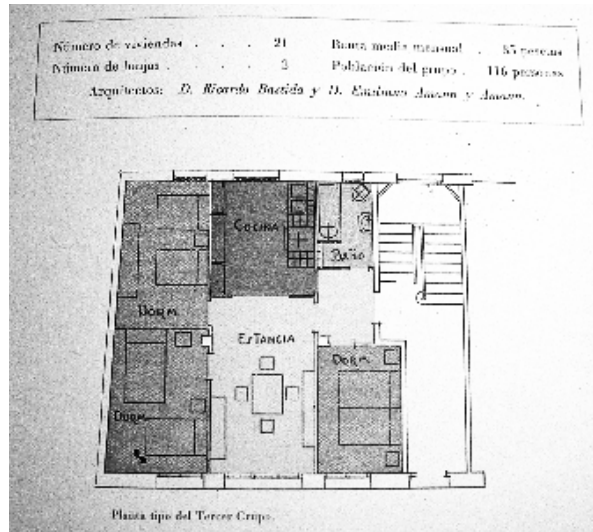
º. Planta de la vivienda de Solokoetxe III (1940). Pág. 6
